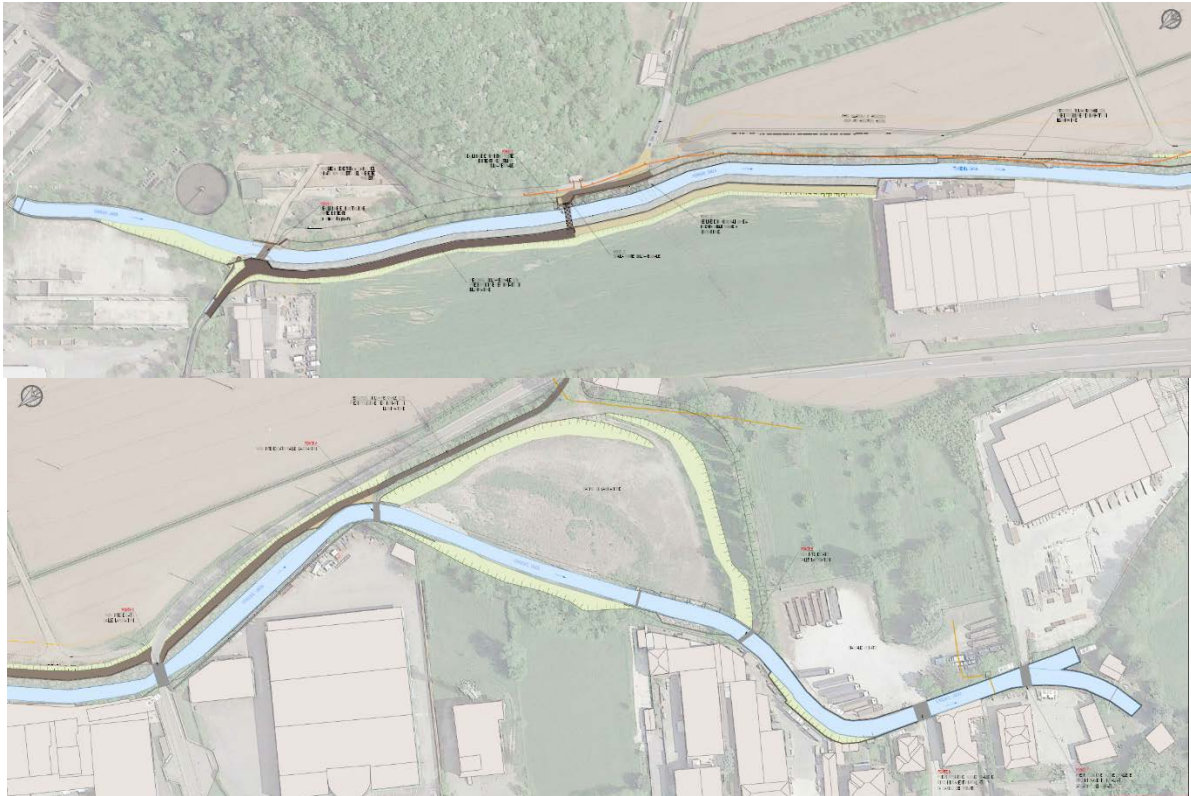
Legenda Tavola 4. Stato di progetto, planimetria generale.
